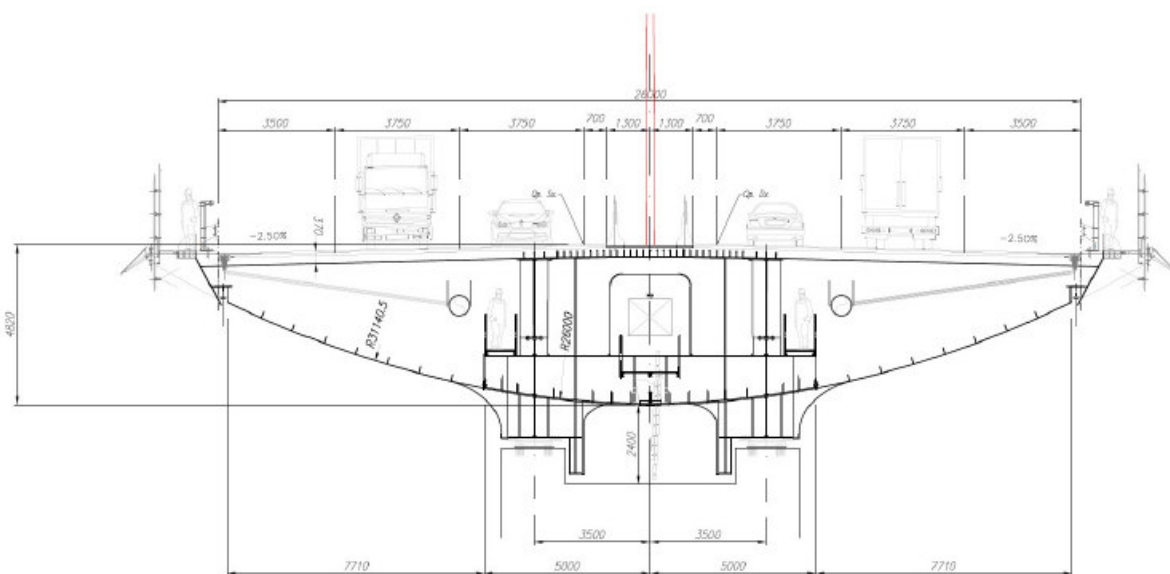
Sezione Pila P10 campata 100 m (scala 1:100)
